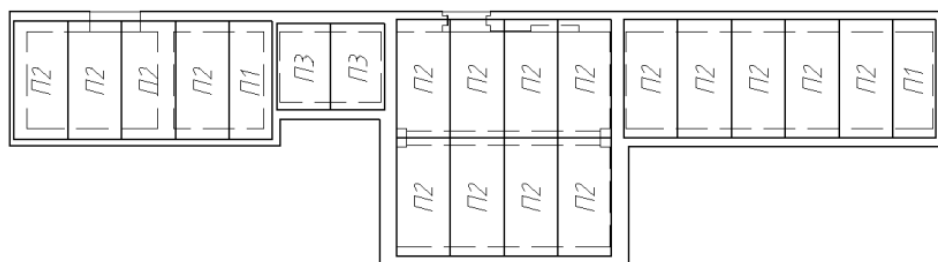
Схема розташування плит перекриття підвального поверху в осях Г-Д
